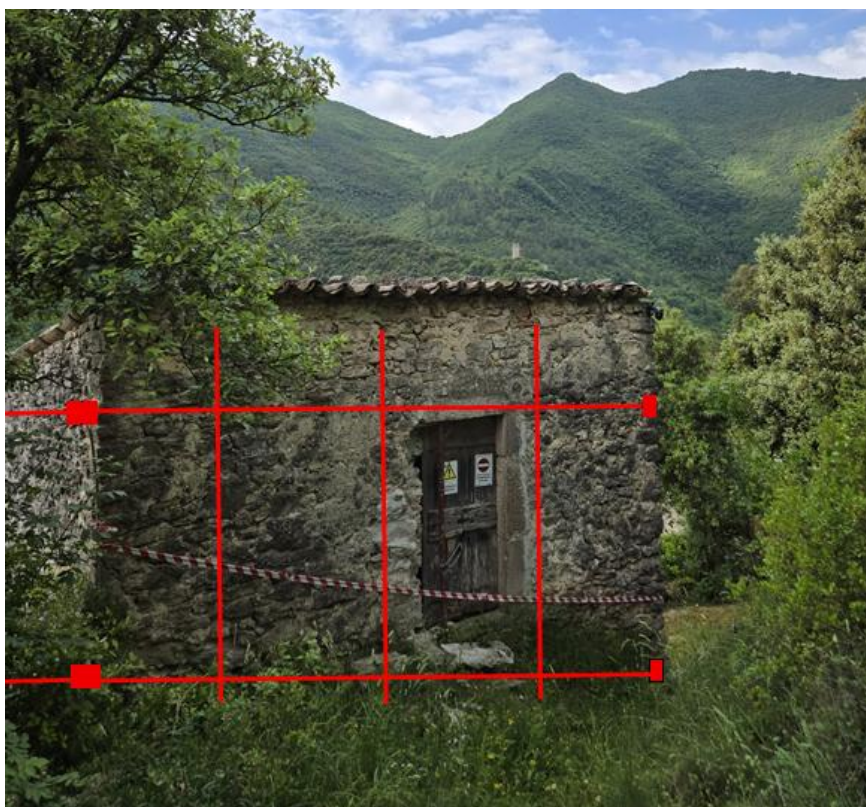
foto inserimenti delle strutture di consolidamento del fabbricato
